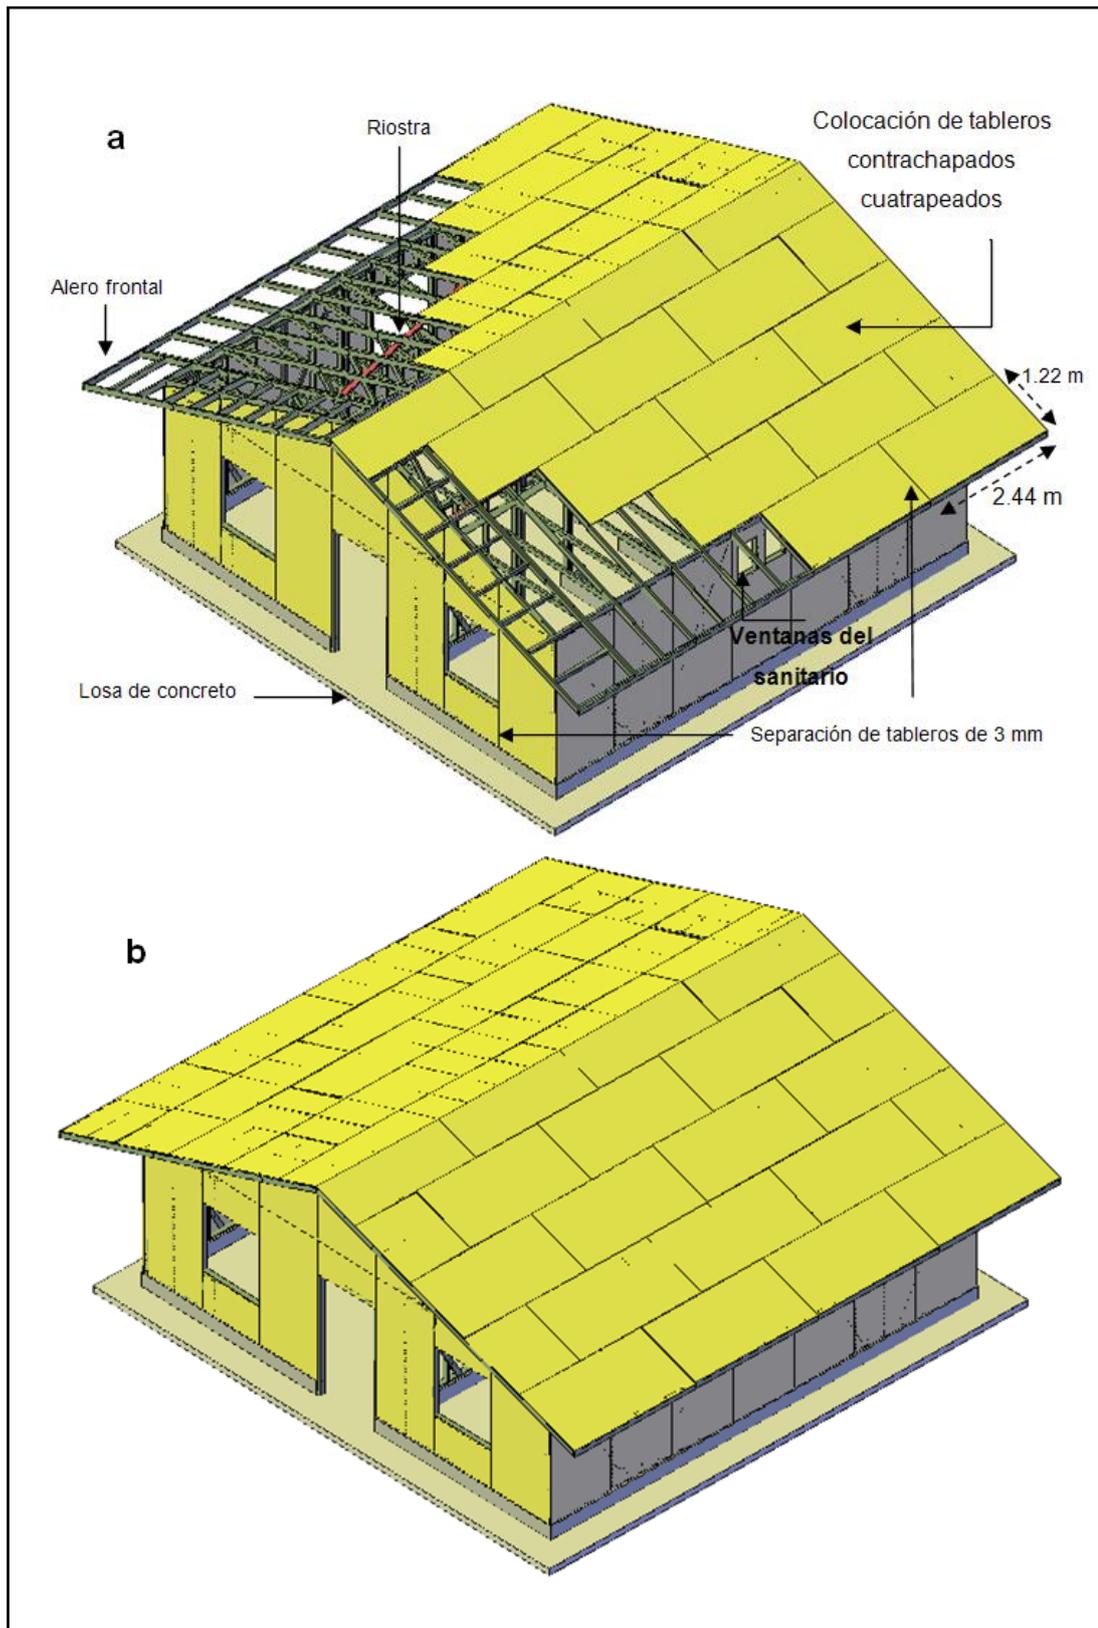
a) Colocación de tableros contrachapados en sentido perpendicular a los apoyos y cuatrapeados; b) Vista de la vivienda con la colocación de tableros exteriores (12 mm, FF) en las fachadas y en el techo.
